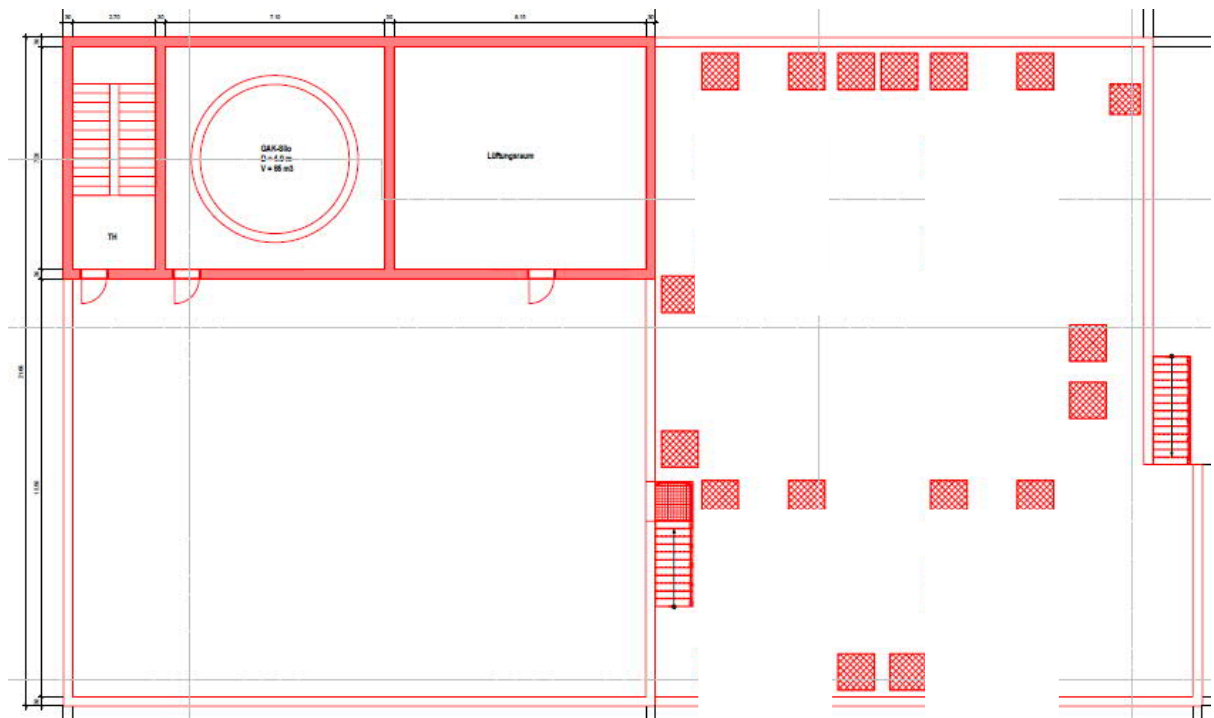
Ausschnitt Grundriss OG
